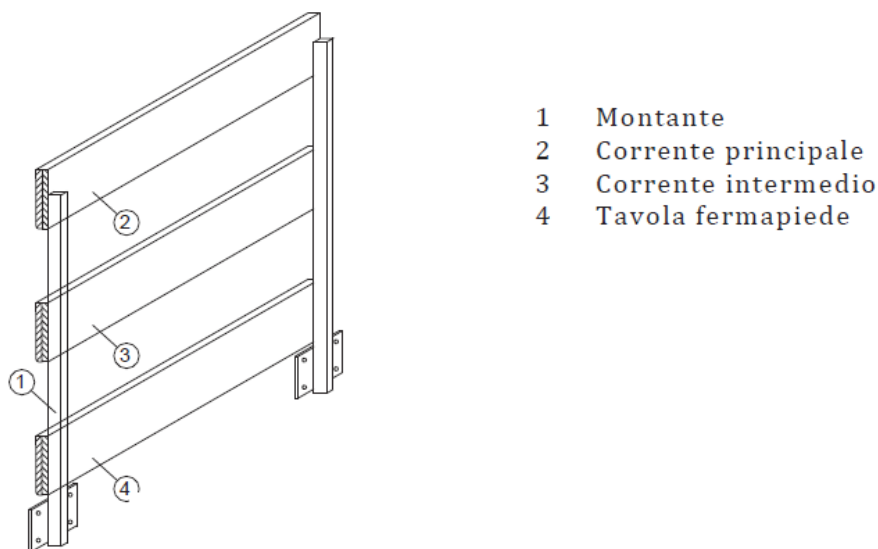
Schematizzazione Parapetto Provvisorio- Fonte: [12]
